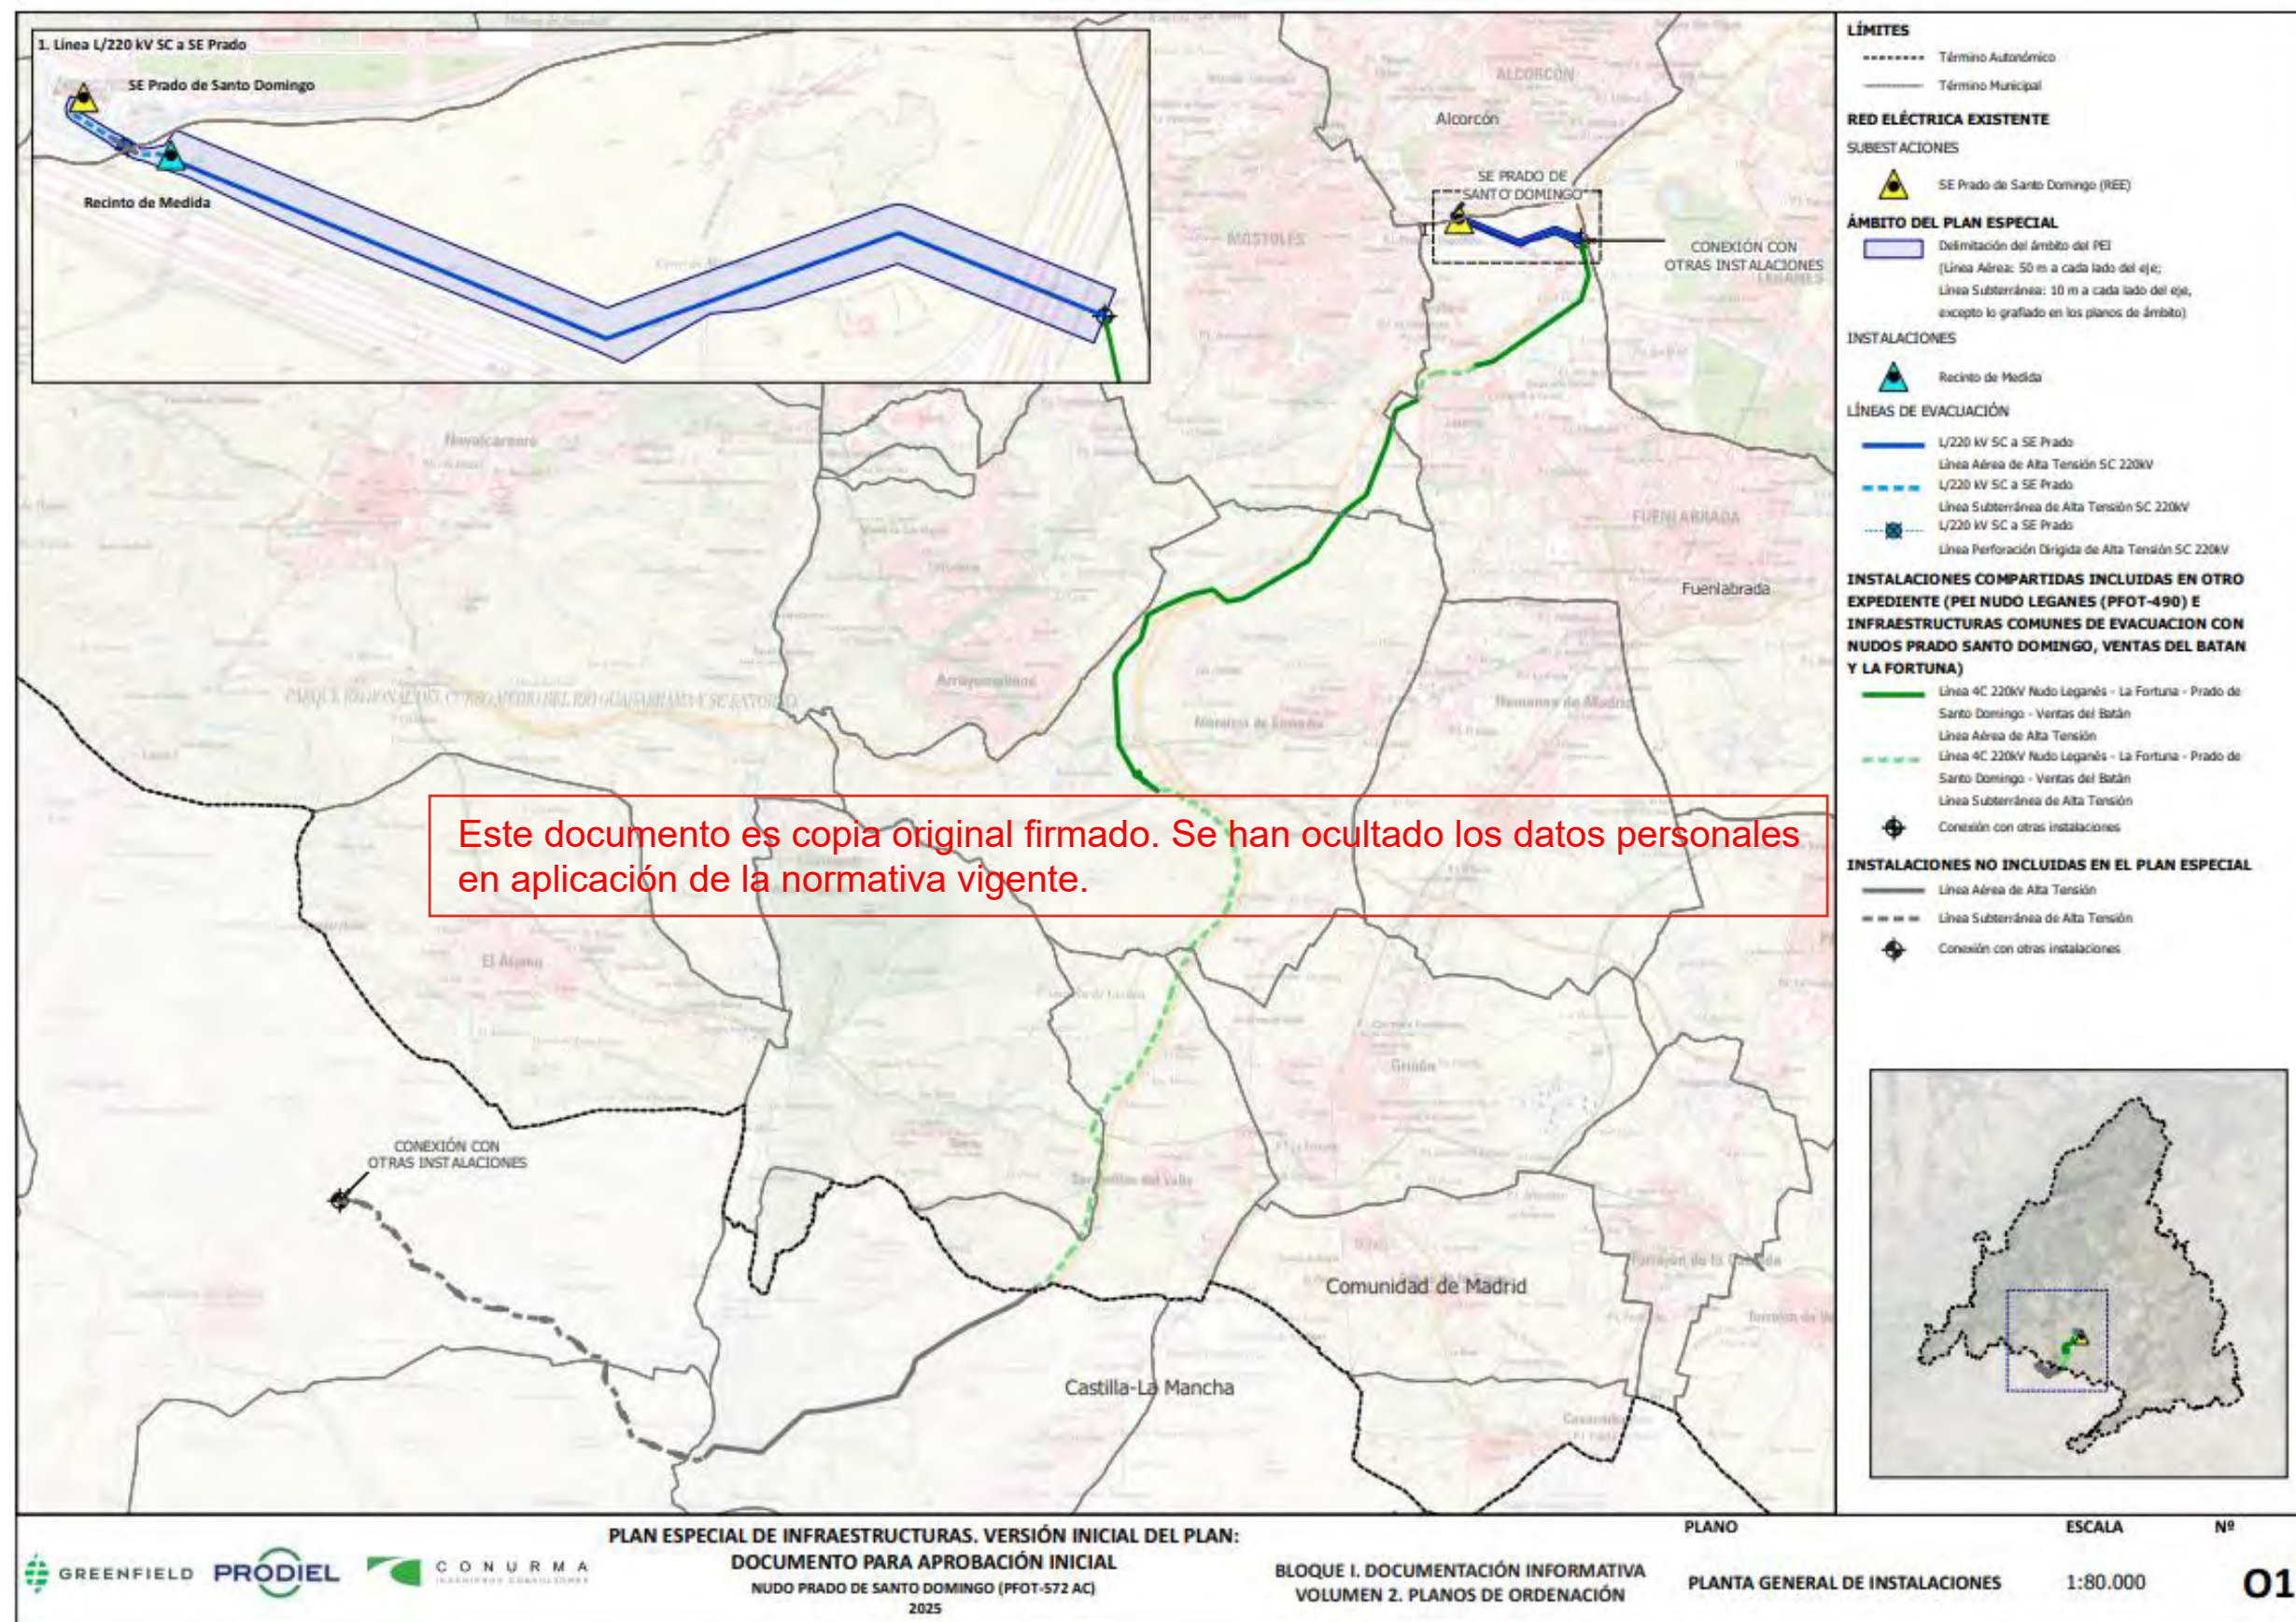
Plano de Situación de las Infraestructuras Comunes de Evacuación
